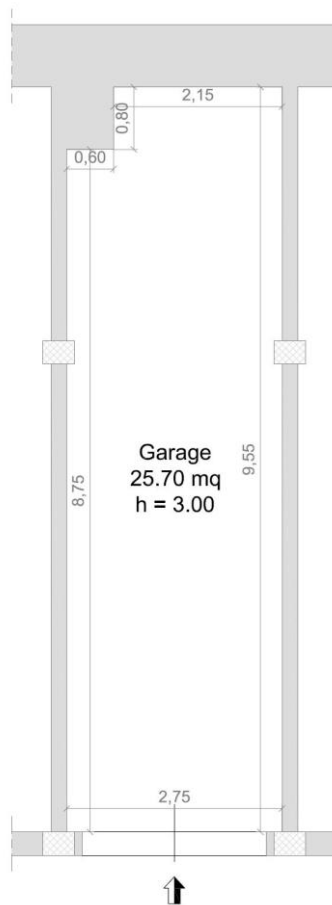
Planimetria Stato di fatto Foglio 29, p.lla 1255, sub 31.
